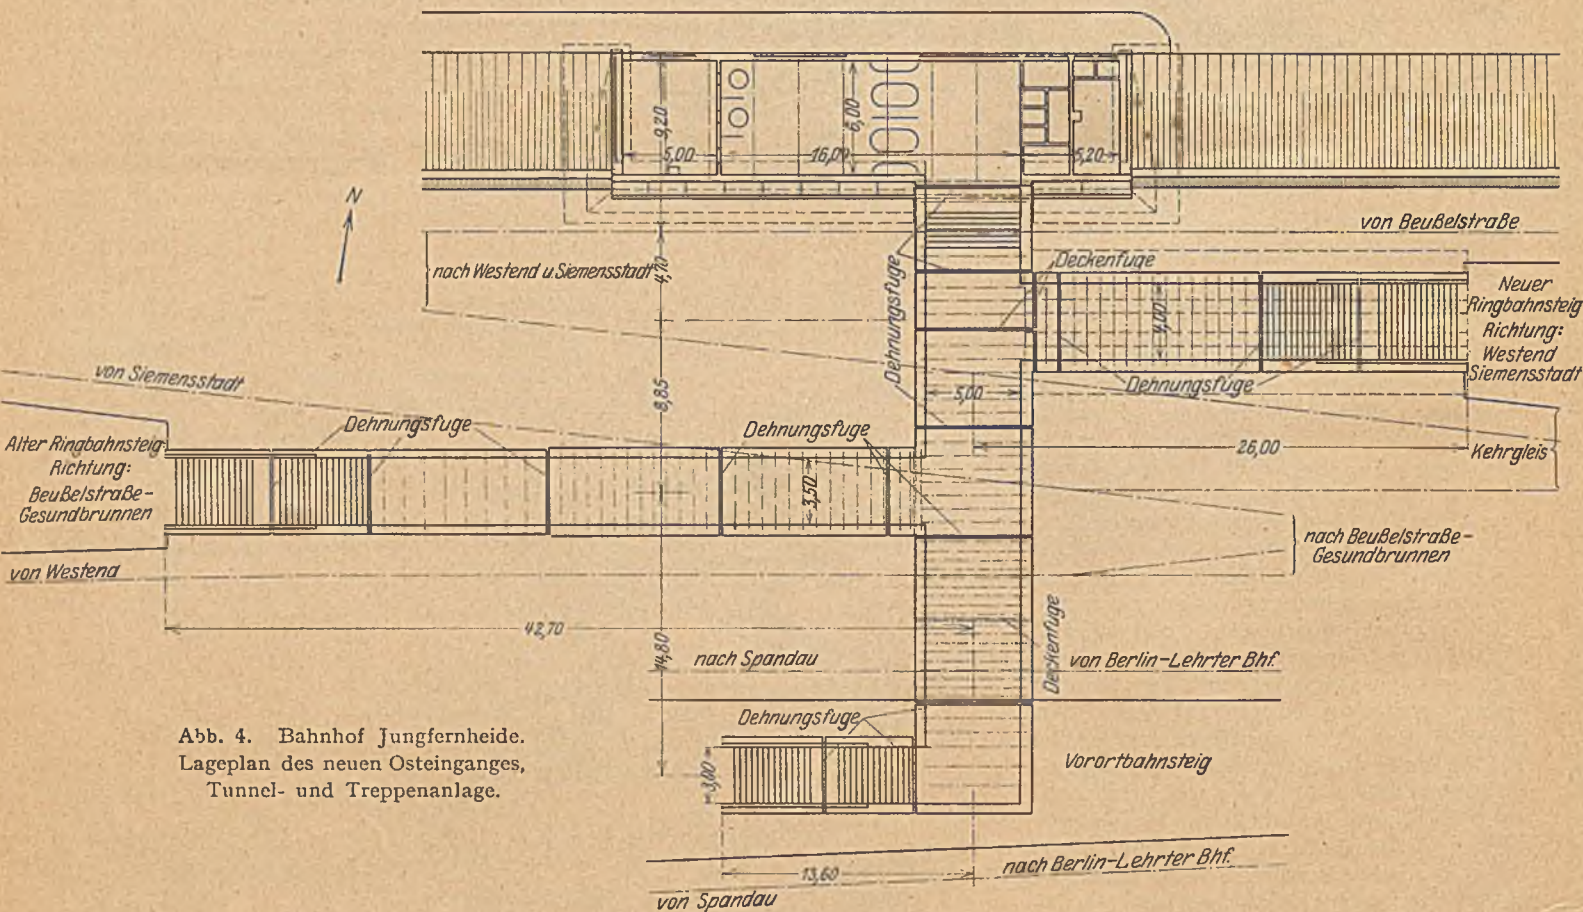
Bahnhof Jungfernheide. Lageplan des neuen Osteinganges, Tunnel- und Treppenanlage.
